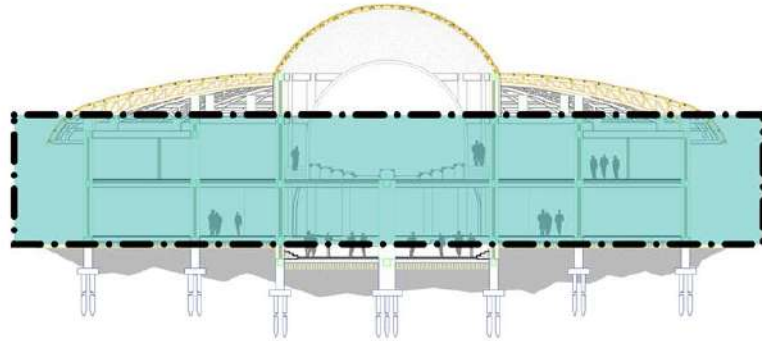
19. Penggunaan Pondasi BorPile Pada Bangunan Mess.
